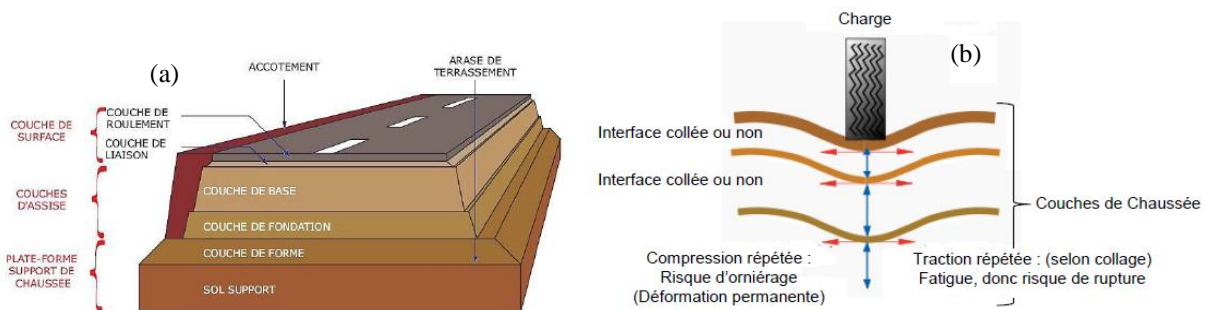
Schéma : (a) structure d'une chaussée routière et (b) Sollicitations dans la chaussée.
